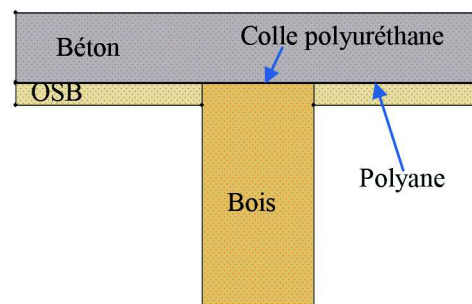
système mixte poutre bois/dalle béton assemblés par collage
